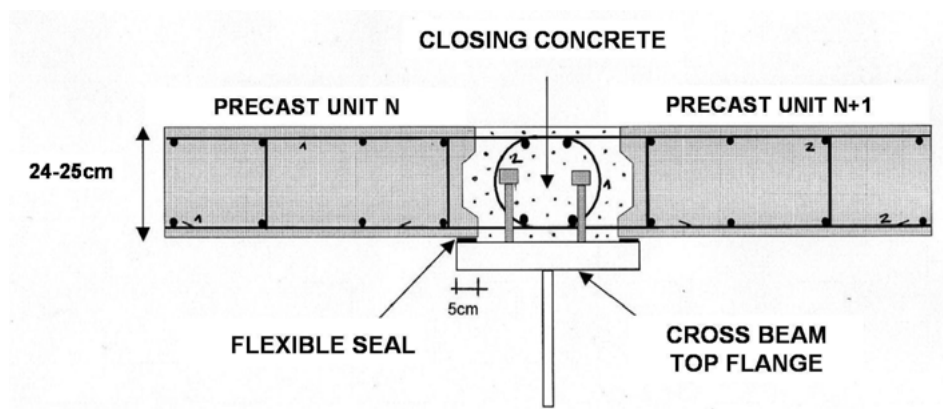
Soluzione di getto con piattabanda della trave che funge da cassero
